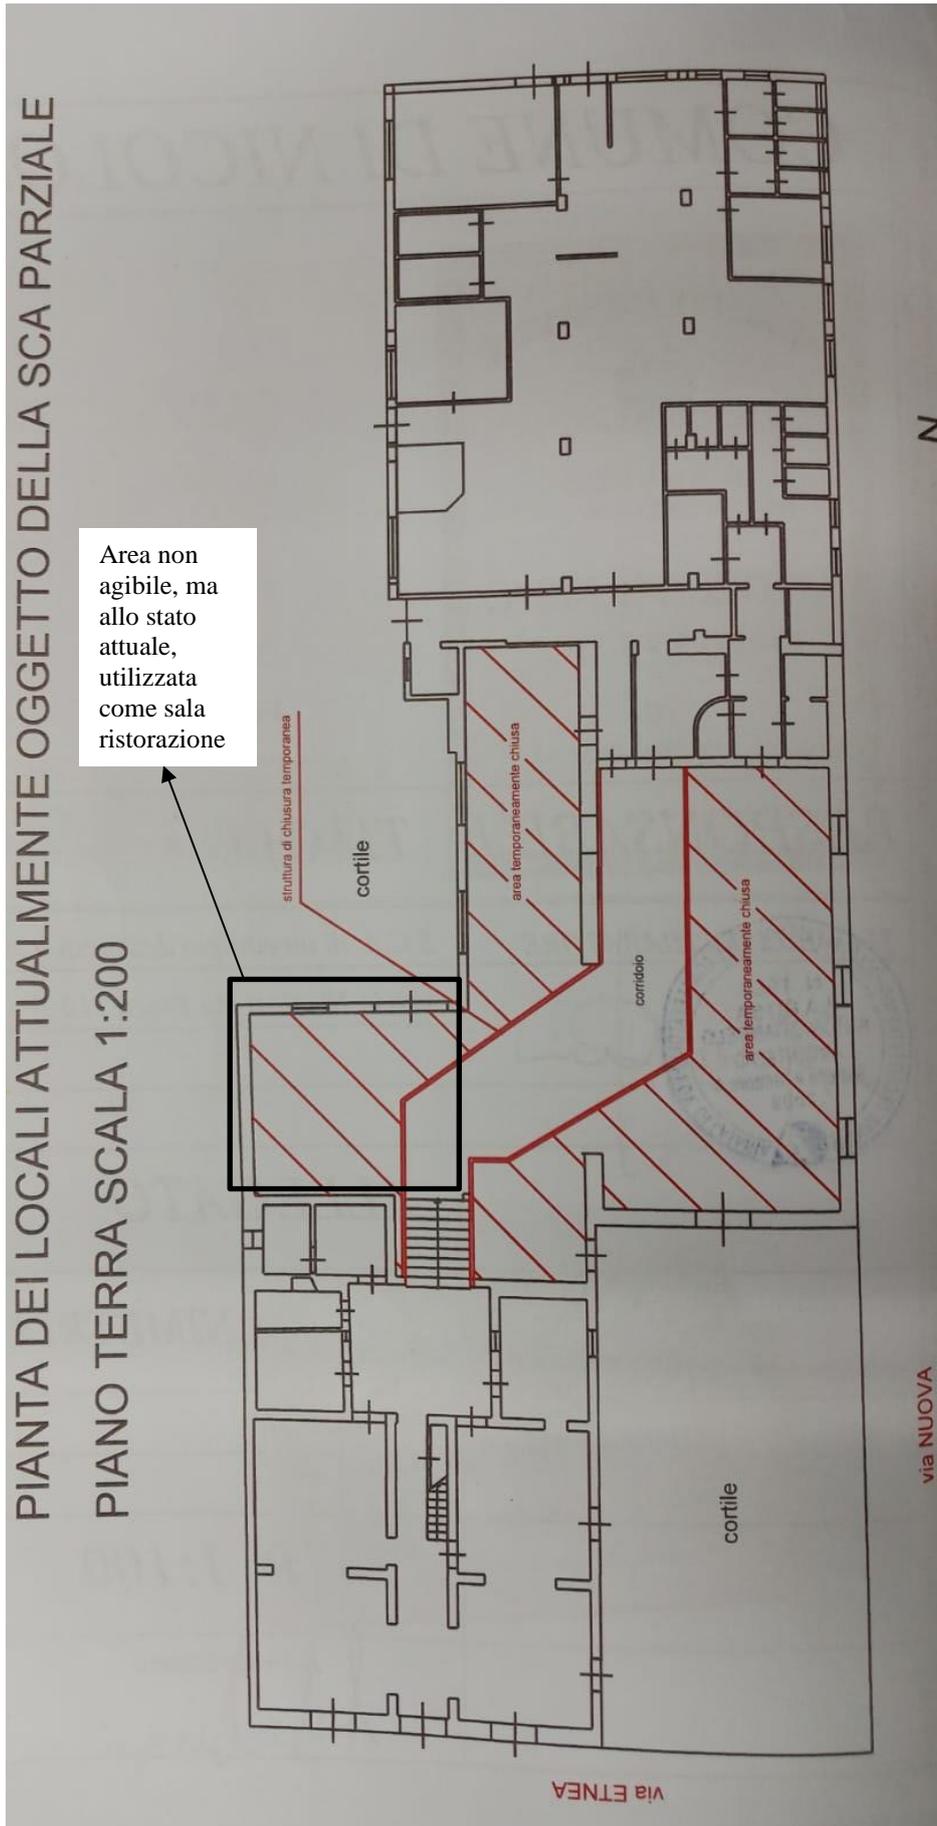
Planimetria piano terra stato di fatto soggetto a SCA
